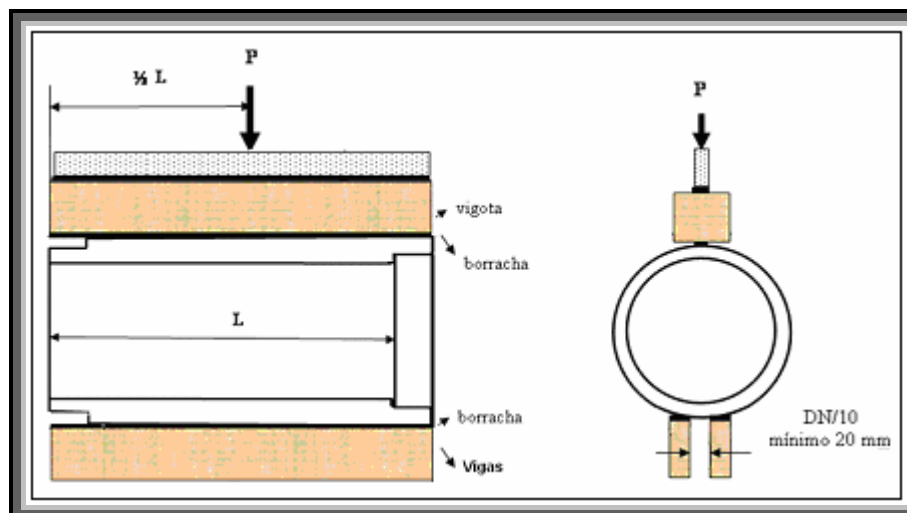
Esquema do ensaio de compressão diametral para tubos de concreto do tipo macho e fêmea
